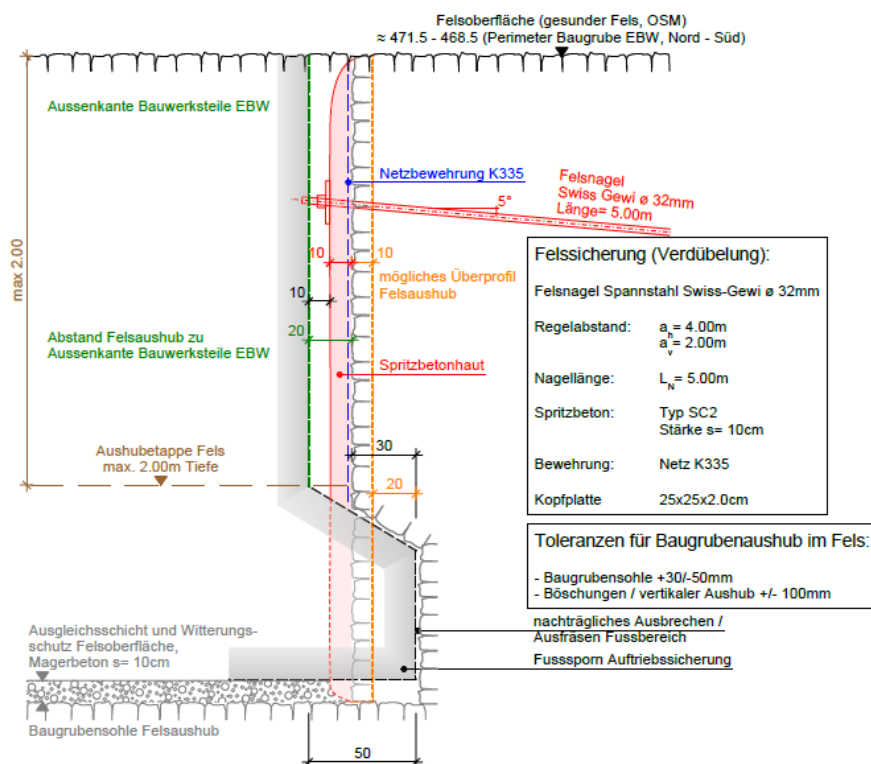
Systemschnitt Felsaushub und -sicherung
